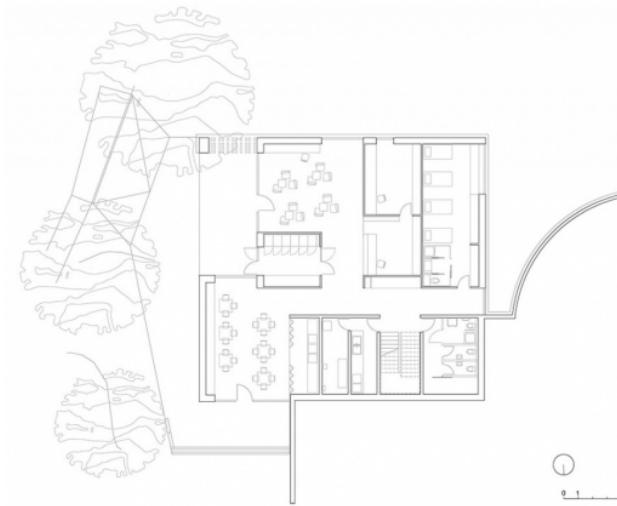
Grundriss EG Jugendherberge Punkl
